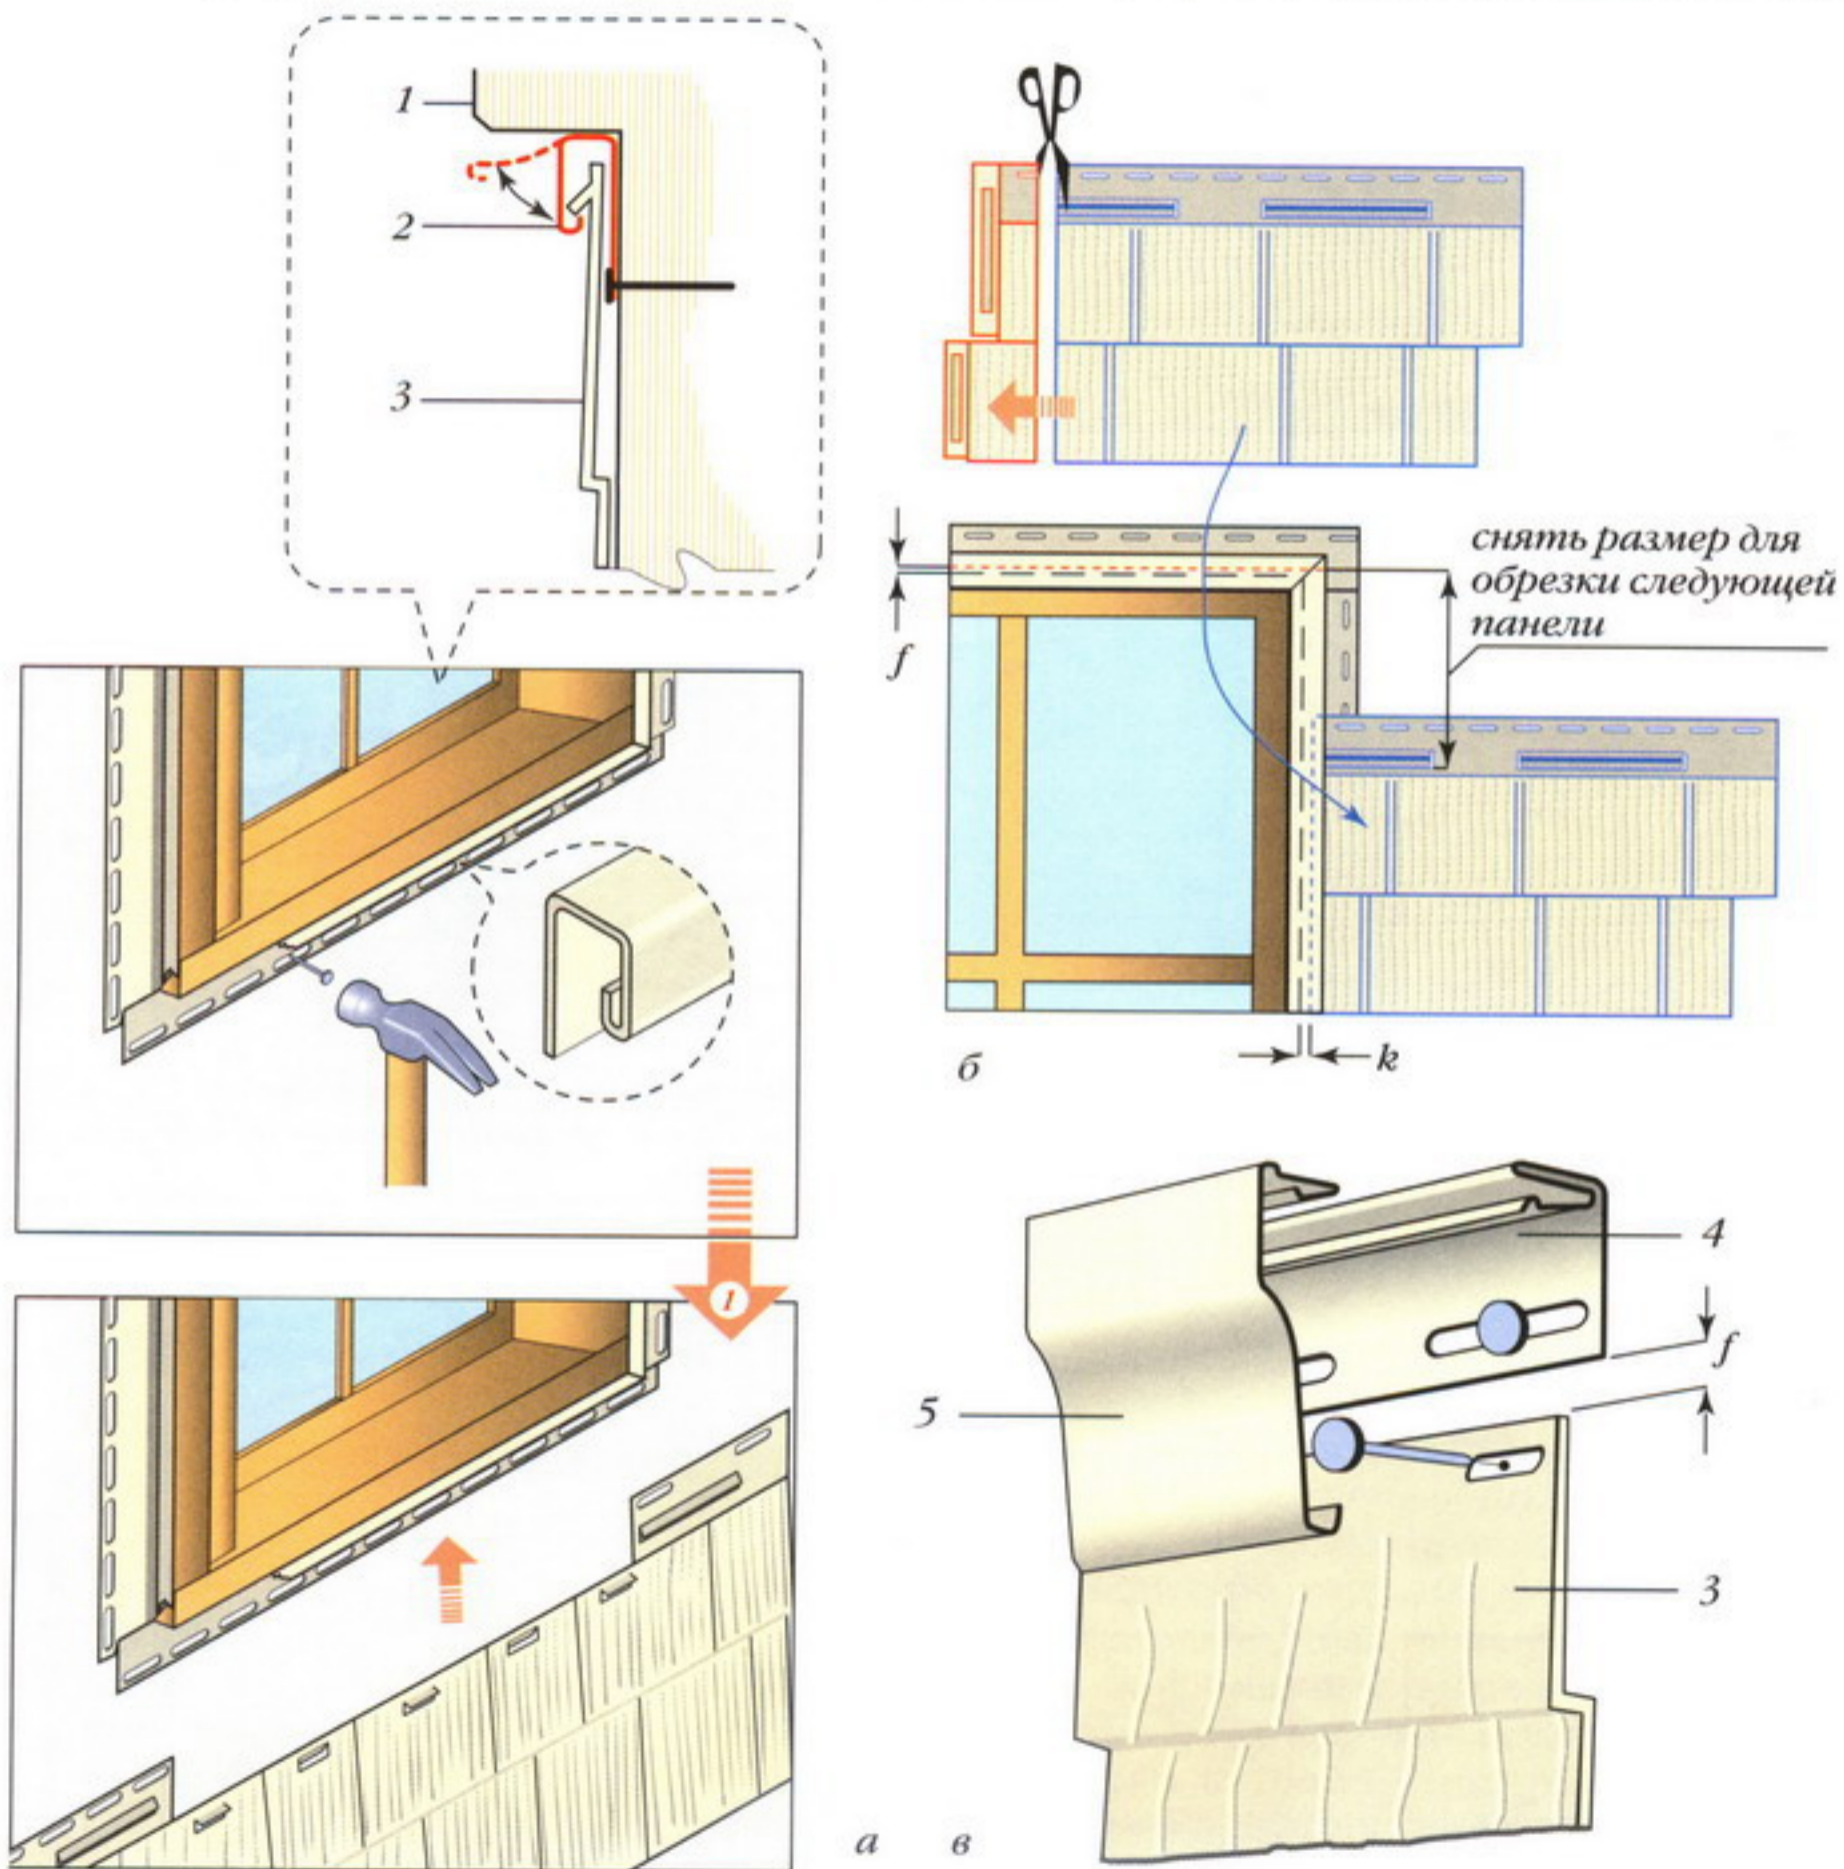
Установка цокольного сайдинга вокруг проемов и под карнизом крыши: а — под проемом; б — сбоку проема; в — под карнизом; 1 — оконная рама или карниз; 2 — J-профиль; 3 — цокольная панель; 4 — принимающий профиль молдинга; 5 — молдинг; k, f — вертикальный и горизонтальный температурные зазоры
